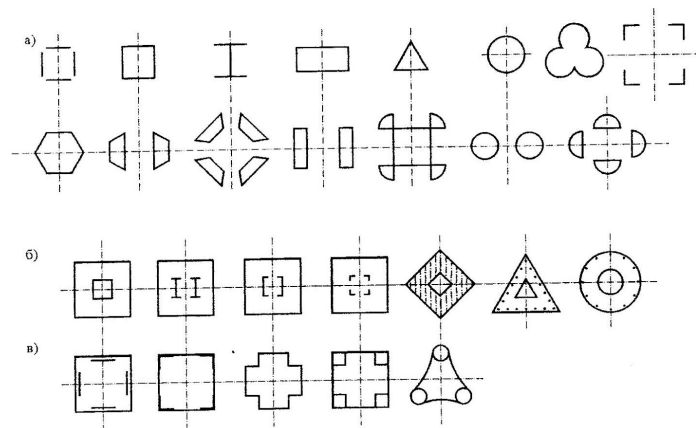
Ствольные здания: а - формы сборных и монолитных стовбов в плане; б - схемы их центрального размещения, в – схемы периферийного размещения
